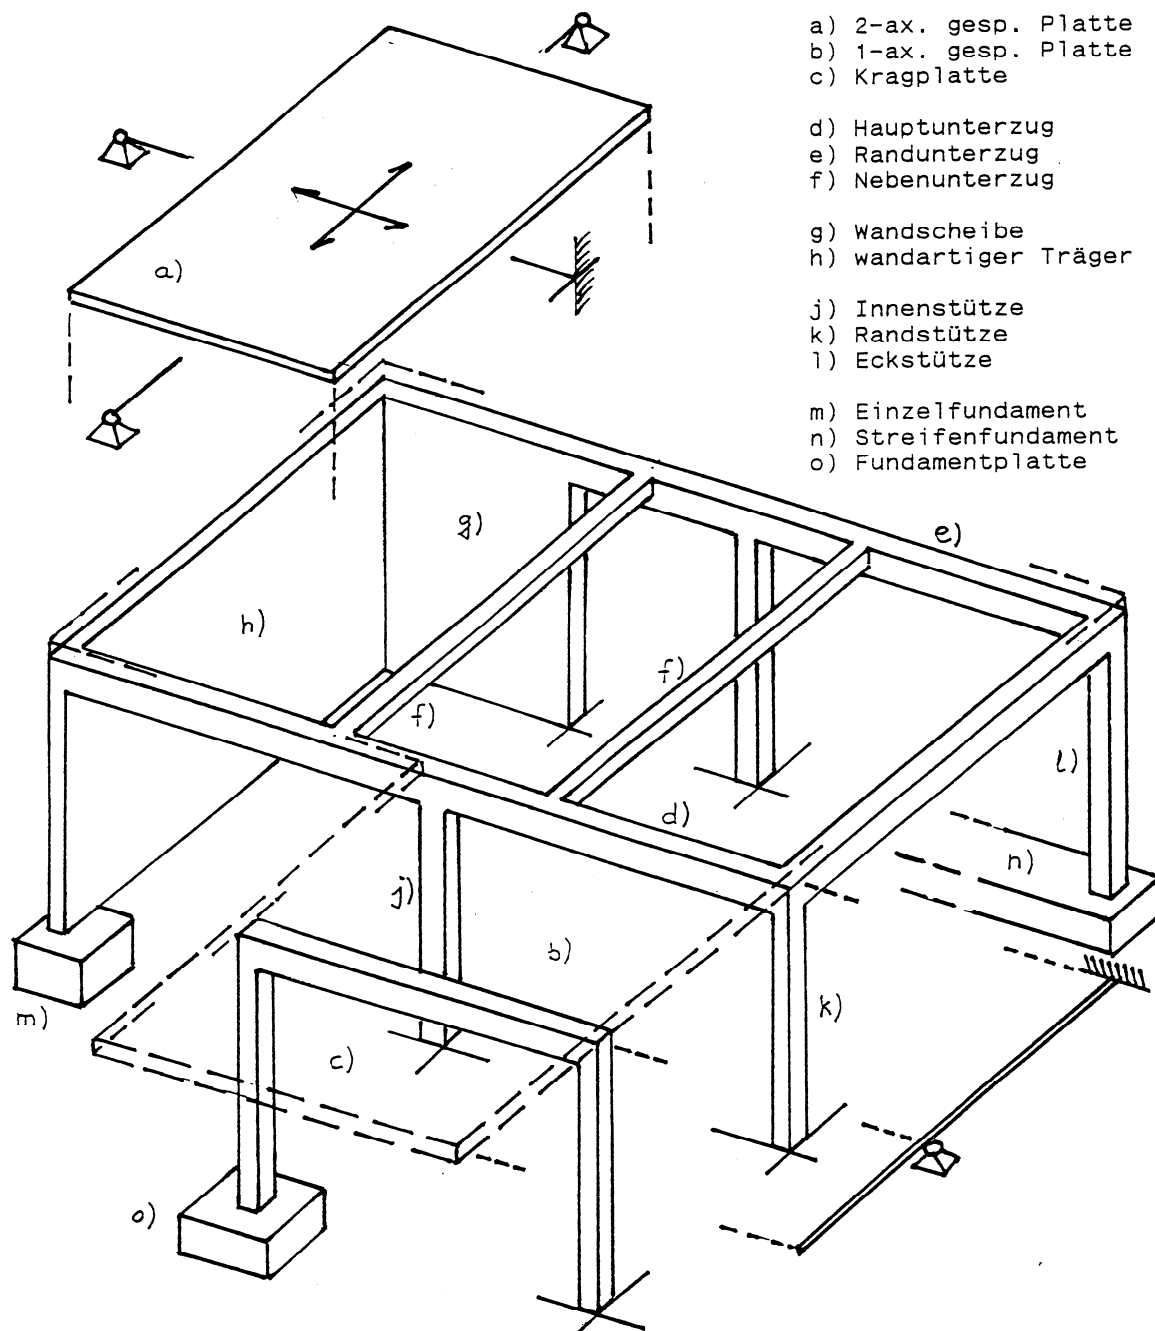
Die vier Bauelemente des Stahlbetonbaus
